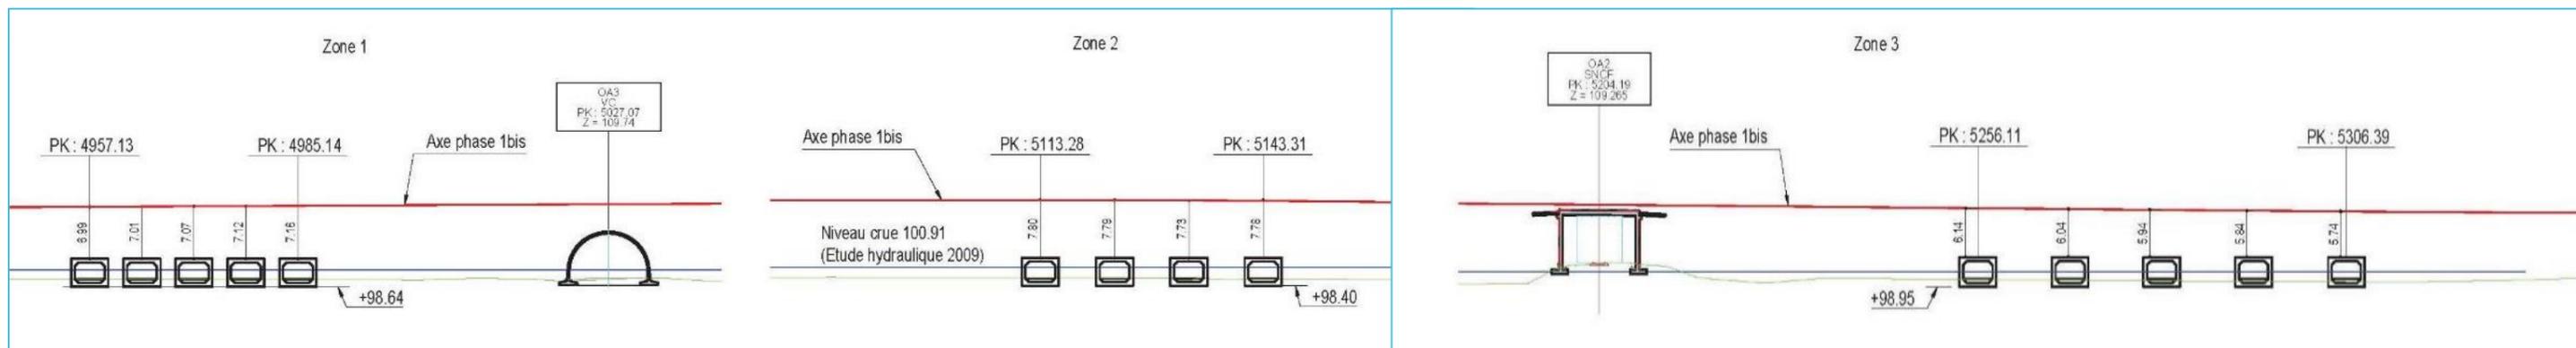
Coupe longitudinale des ouvrages de décharge (source : Setec 2023)
